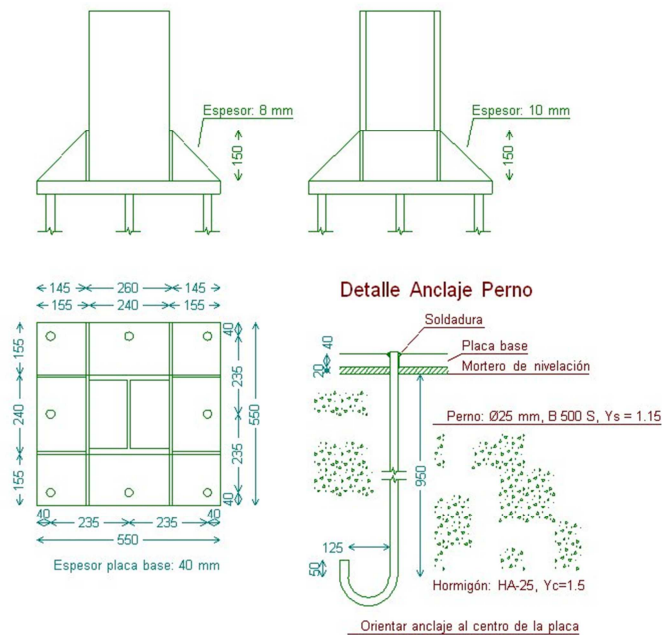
Detalle de las placas de anclaje de los pilares centrales de pórticos de fachada
